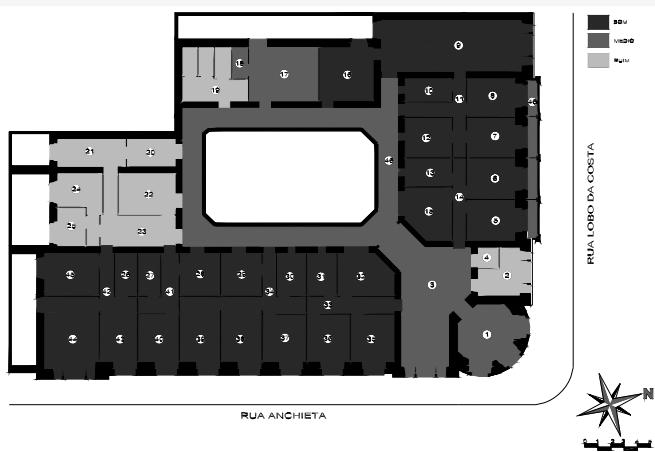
Planta Baixa do 2º Pav. – Estado de Conservação. Desenho: Cristiane Müller.
